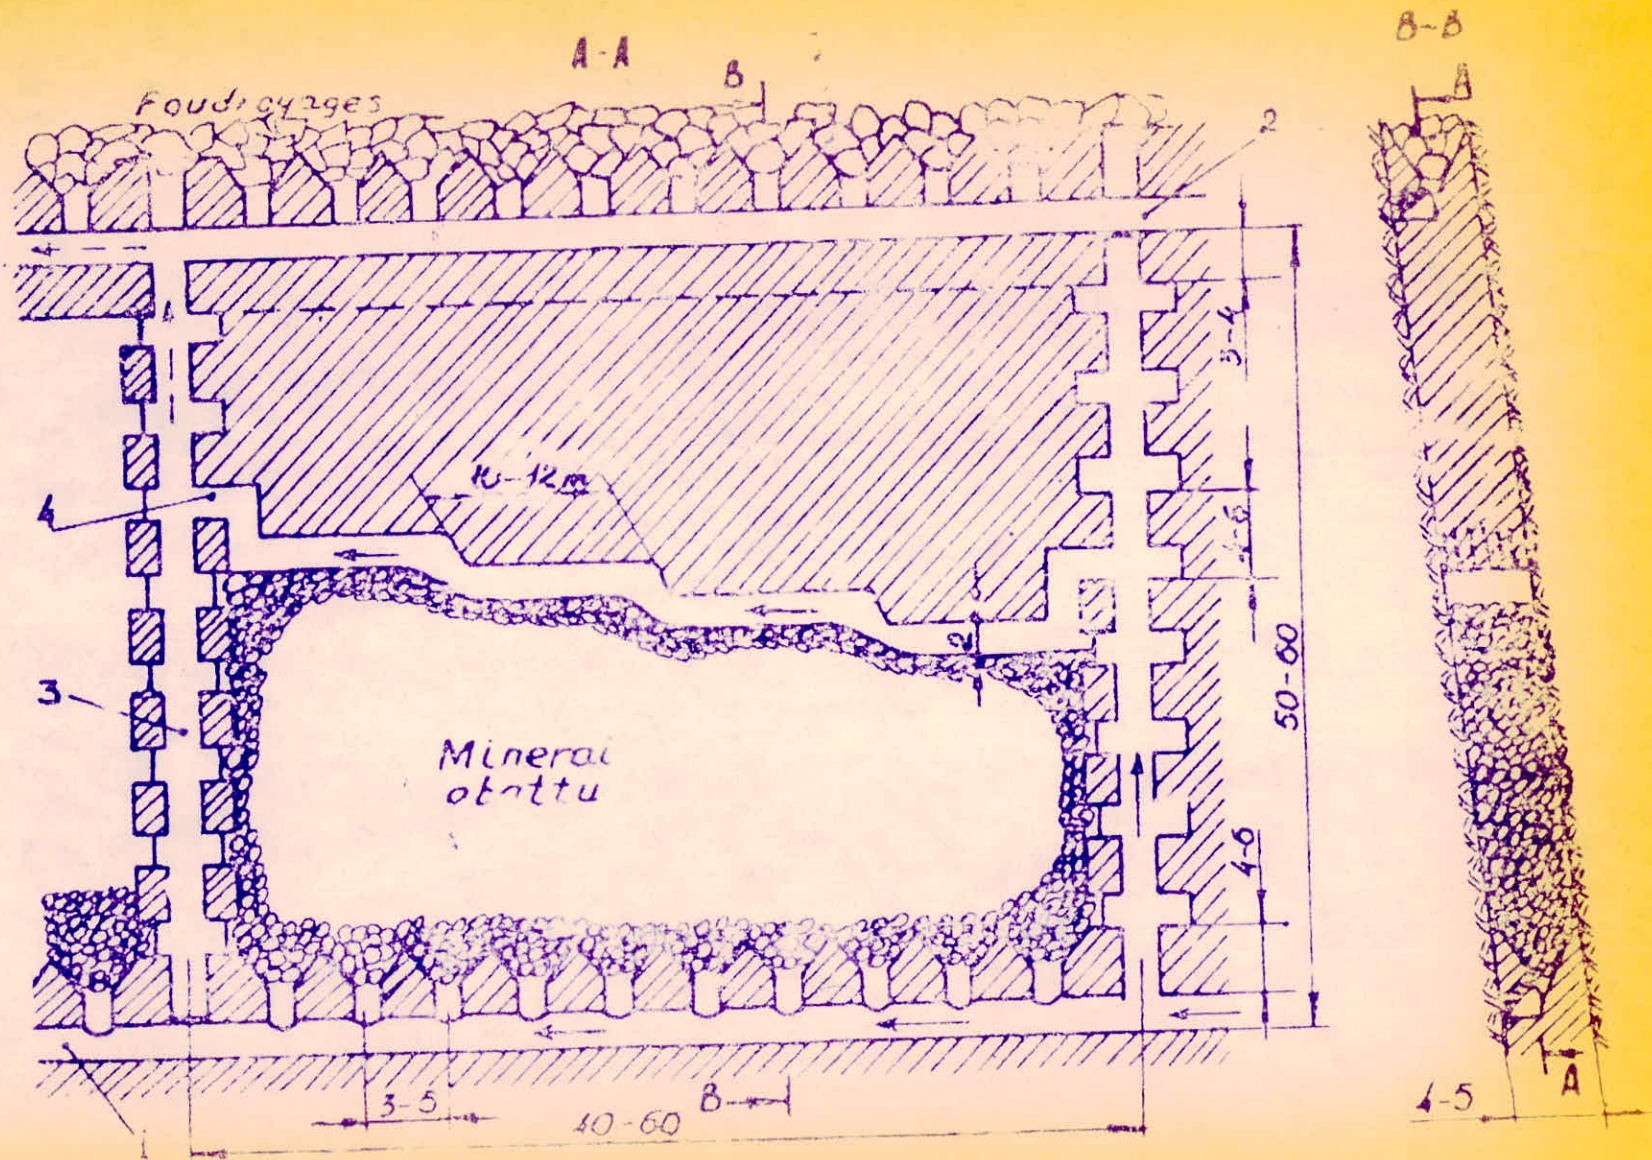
(mur en maçonnerie) - 1 - galerie de roulage ; 2 - galerie d'aerage ;
